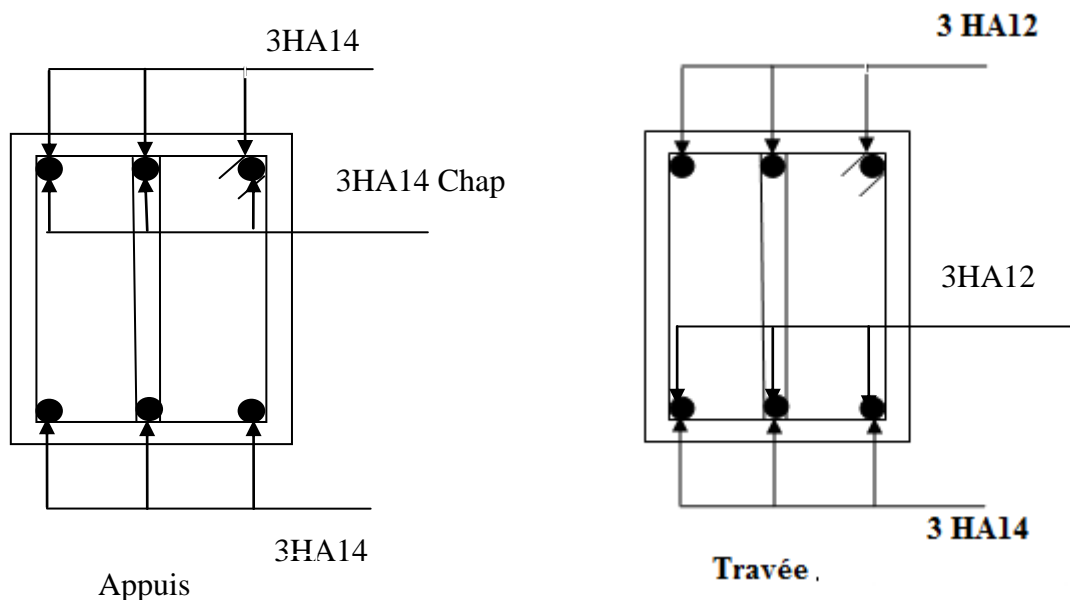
Schéma de ferrailage des poutres principales pour les étages courant
